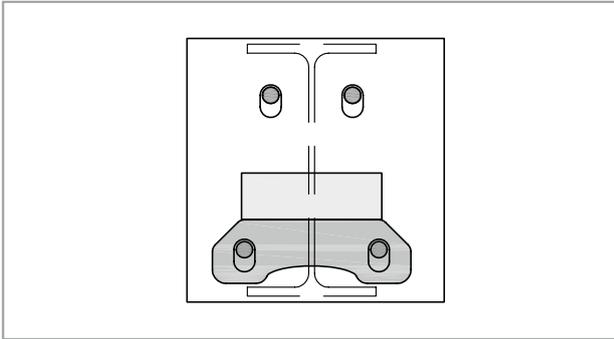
Schöck Isokorb®: Conexión Acero – Hormigón armado; la mordaza de sujeción in situ se encuentra directamente sobre la placa de absorción de carga
